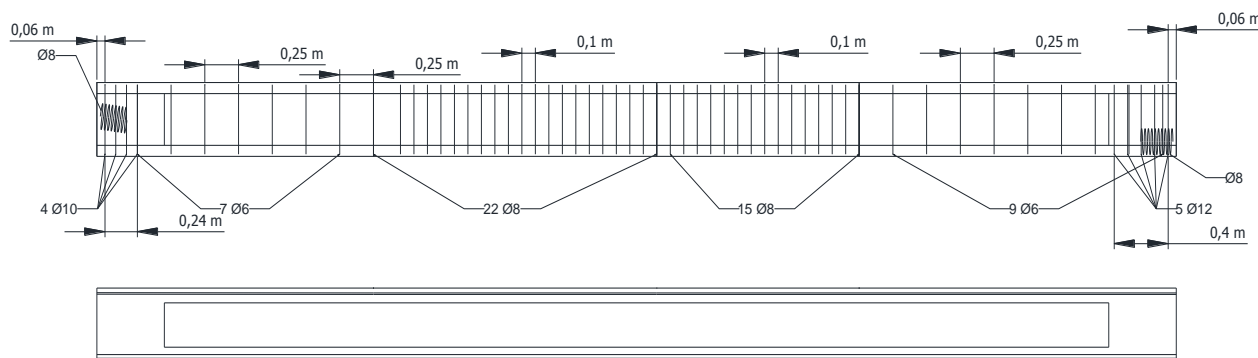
Despiece de armadura transversal y longitudinal.
